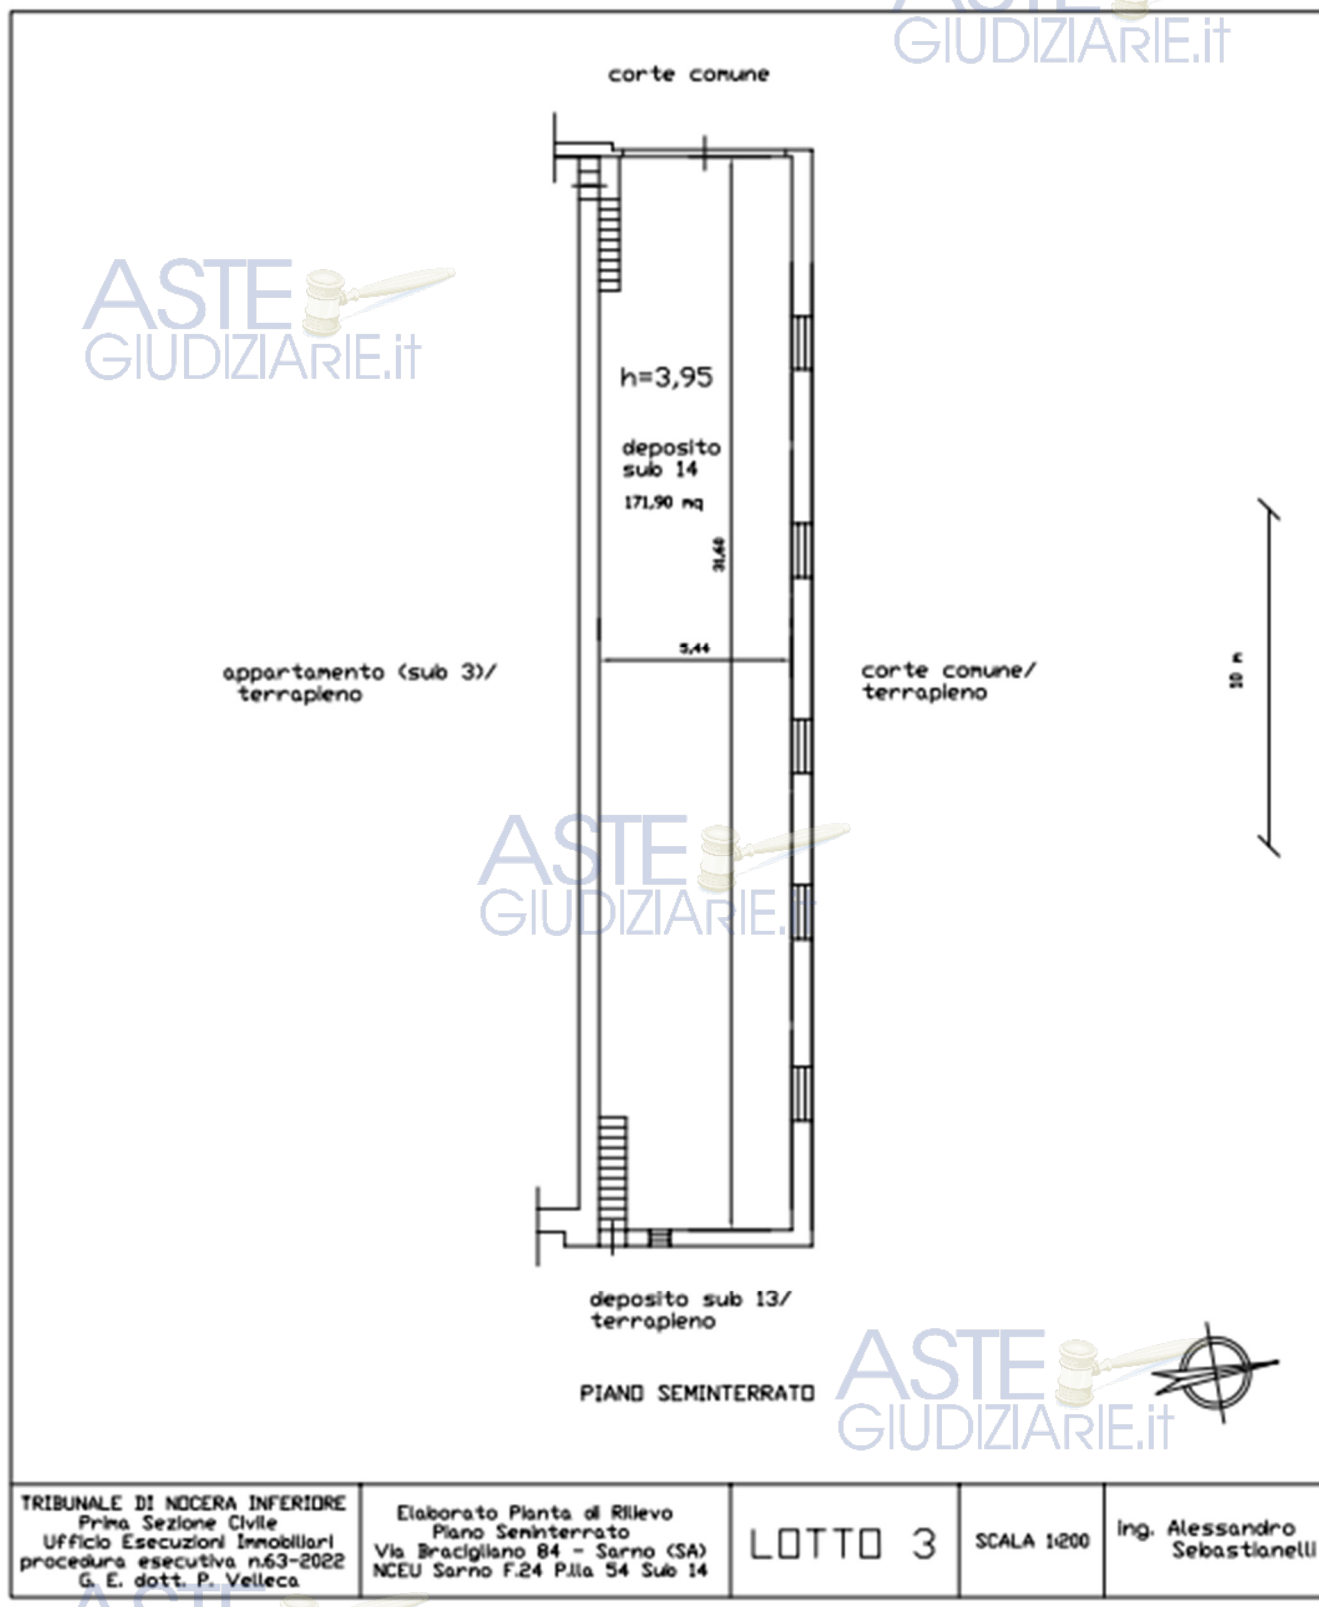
Planimetria stato di rilievo deposito lotto 3 (F.24 p.Ila 54 sub 14)
